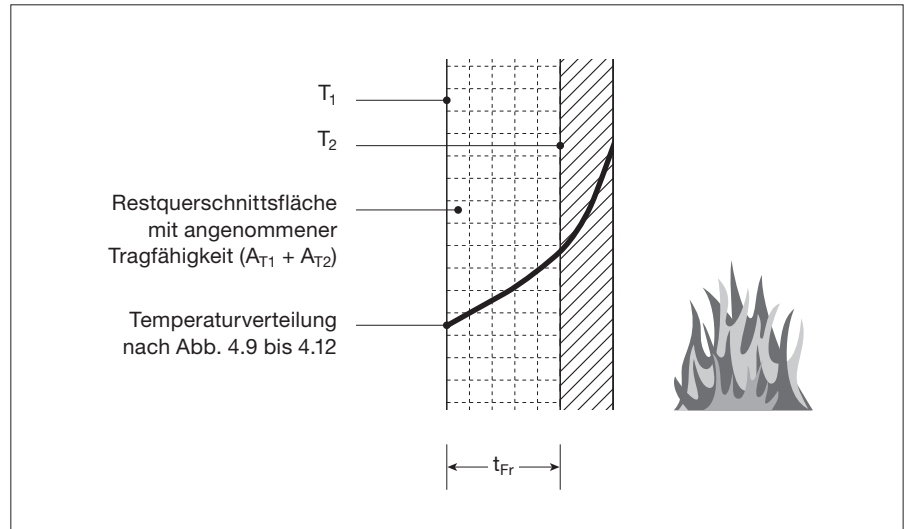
Vertikaler Schnitt durch eine Porenbetonwand
